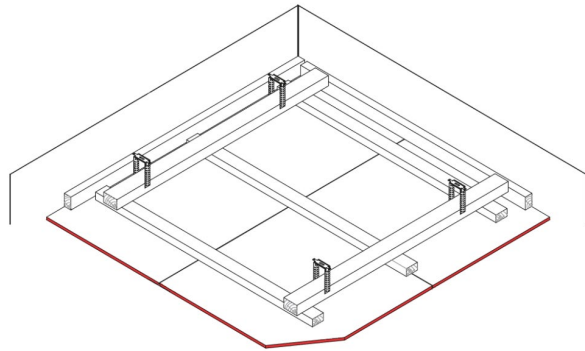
Unterdecke mit Holzunterkonstruktion
